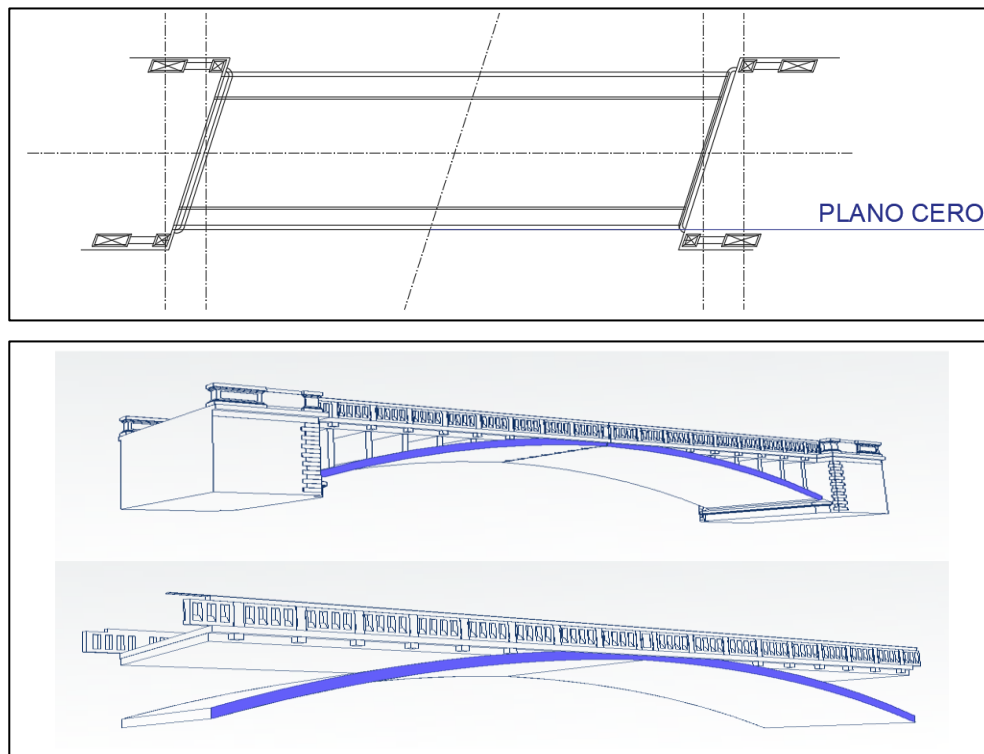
Zona de apoyo del plano cero. Fuente: de los autores
